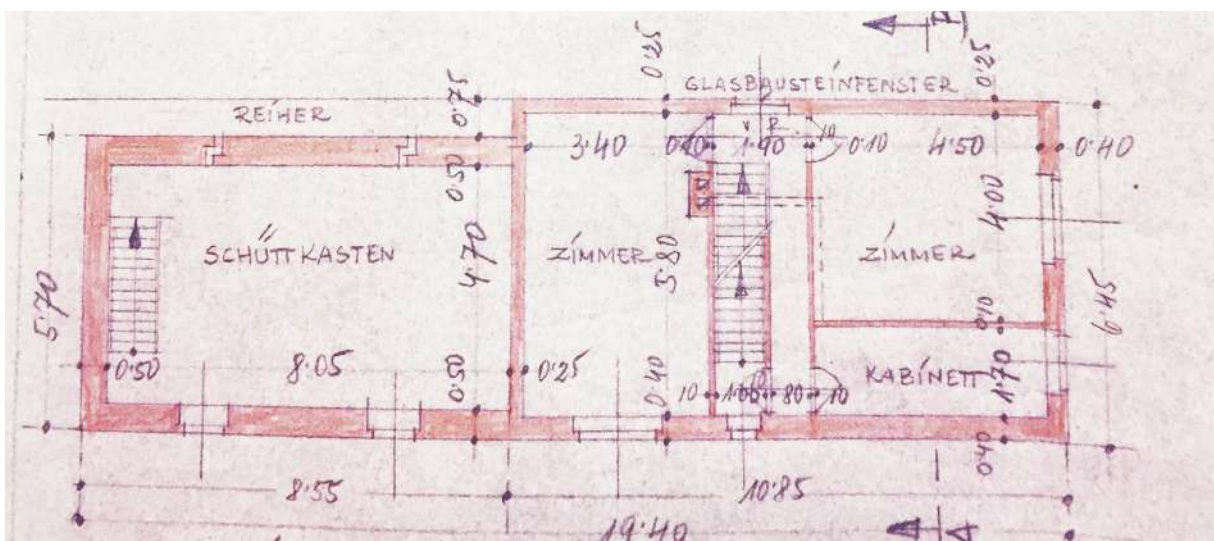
Grundriss Obergeschoss, 1955
